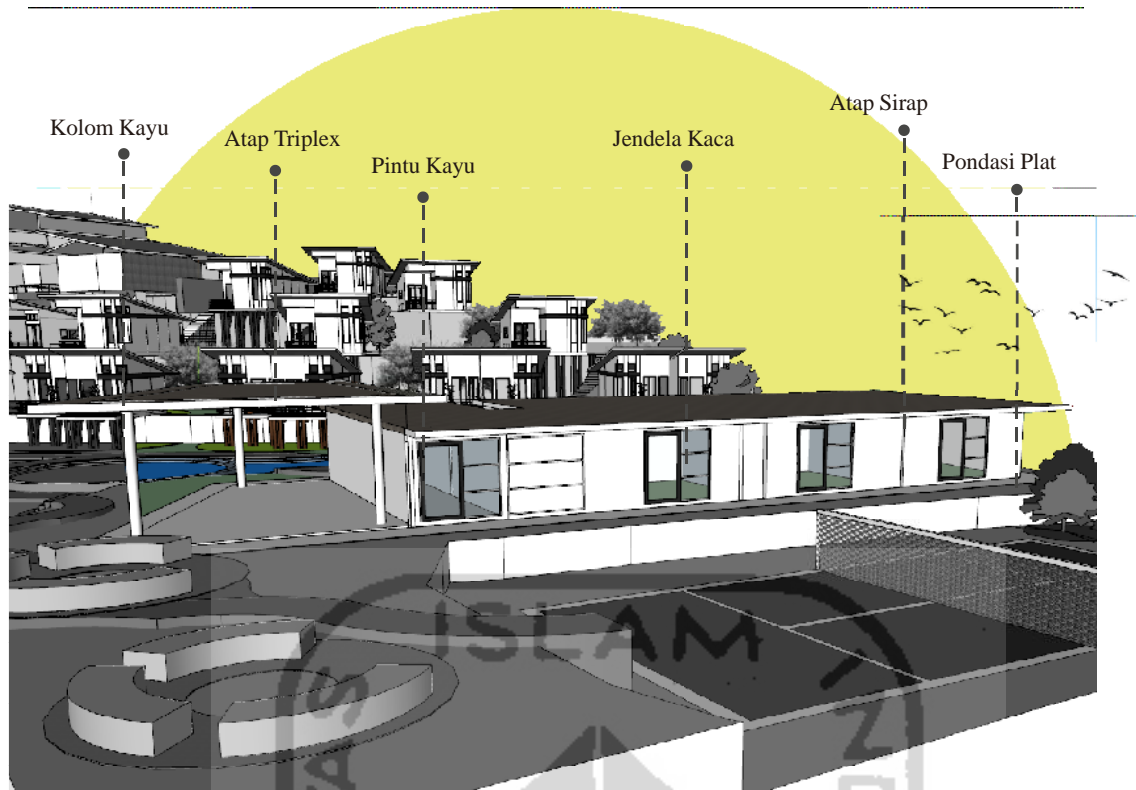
6 Konsep Layout Ruang Pada Bangunan Publik
